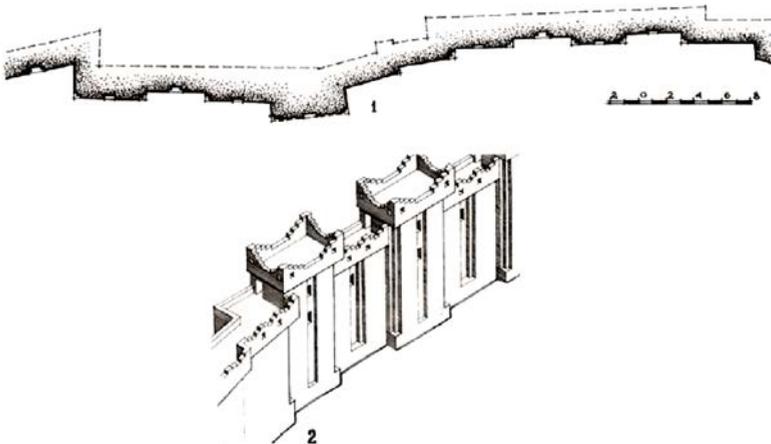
Le plan de la forteresse de la ville d'Artachat
